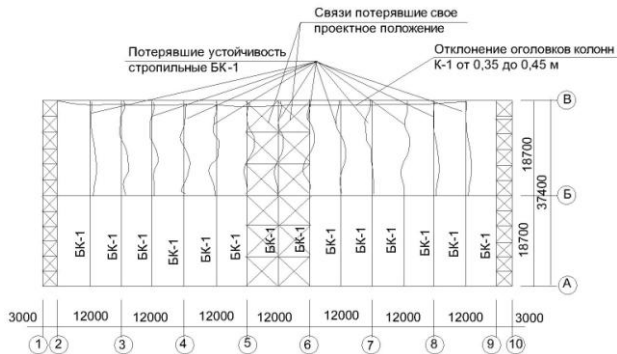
План складского здания с указанием конструкций, которые пострадали во время произошедшей аварии / The plan of the warehouse building with an indication of the structures that were damaged during the accident that occurred
